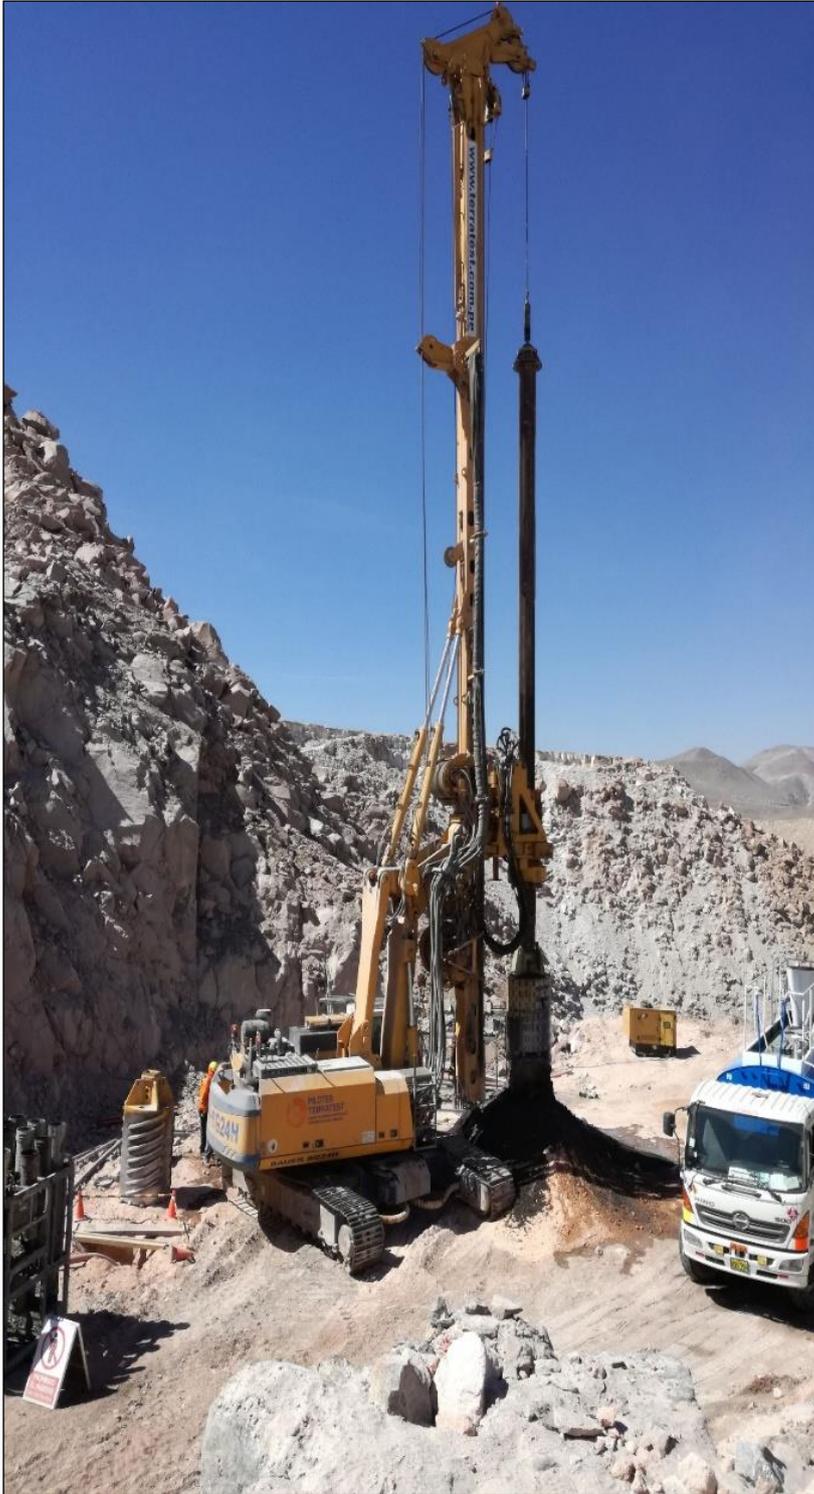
Perforación para pilotes en pilar 9 con pilotera
